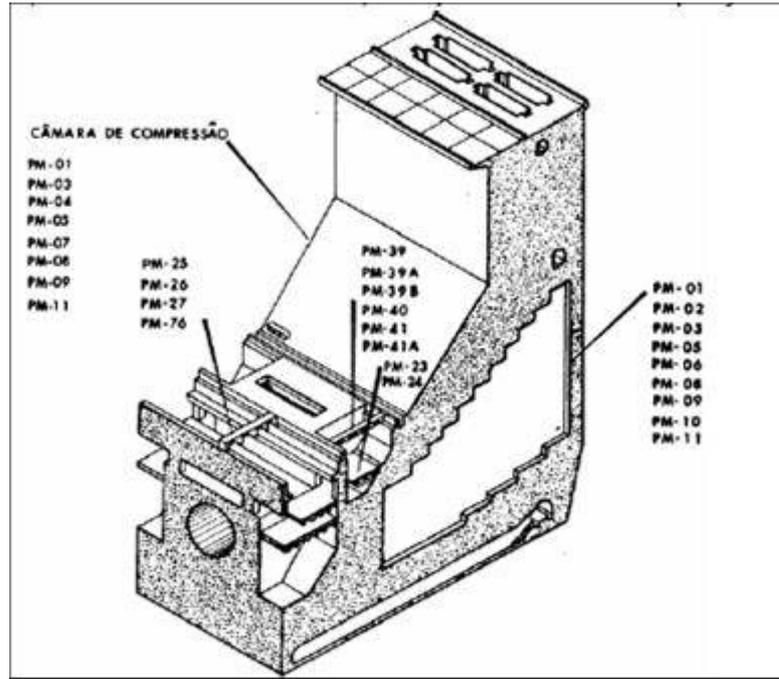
Câmara de compensação de pressão utilizada inicialmente em Ilha Solteira (1970)
